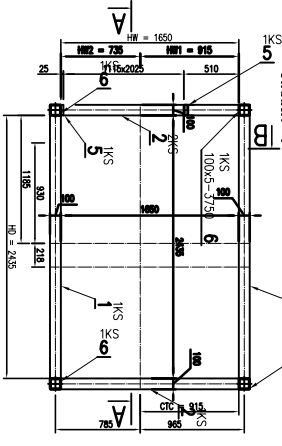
DETAIL MONTÁŽNEHO OKA V STROPE ŠAČTY
